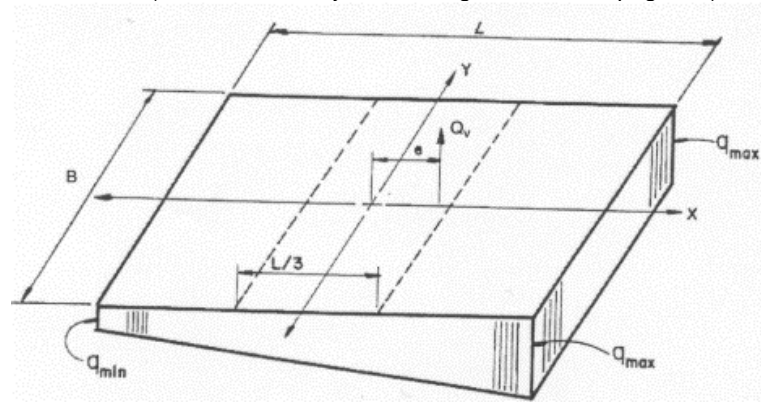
Distribución de los esfuerzos bajo el cimiento en una dirección.
